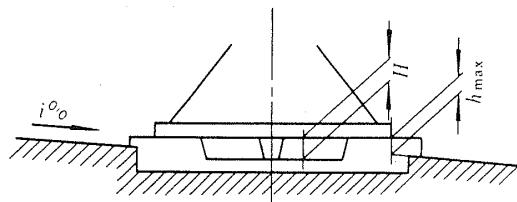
横断勾配がある場合の支承座⁹⁵⁾
